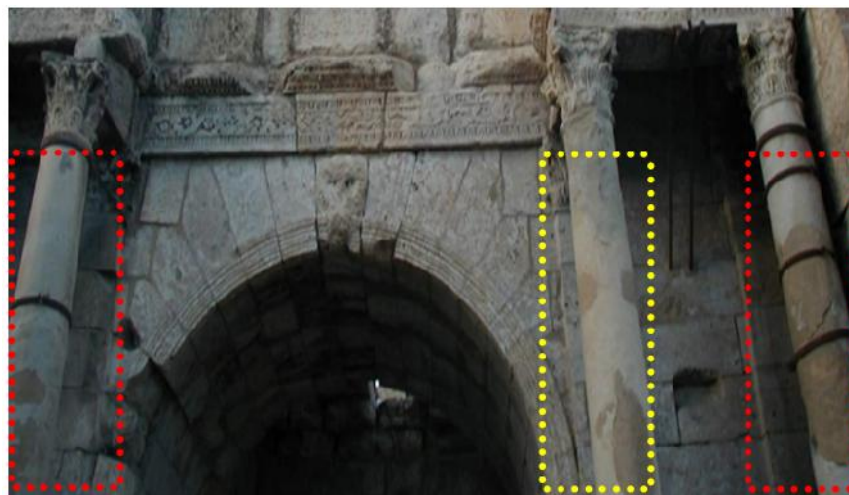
Fissures au niveau des colonnes, source : l'auteur
